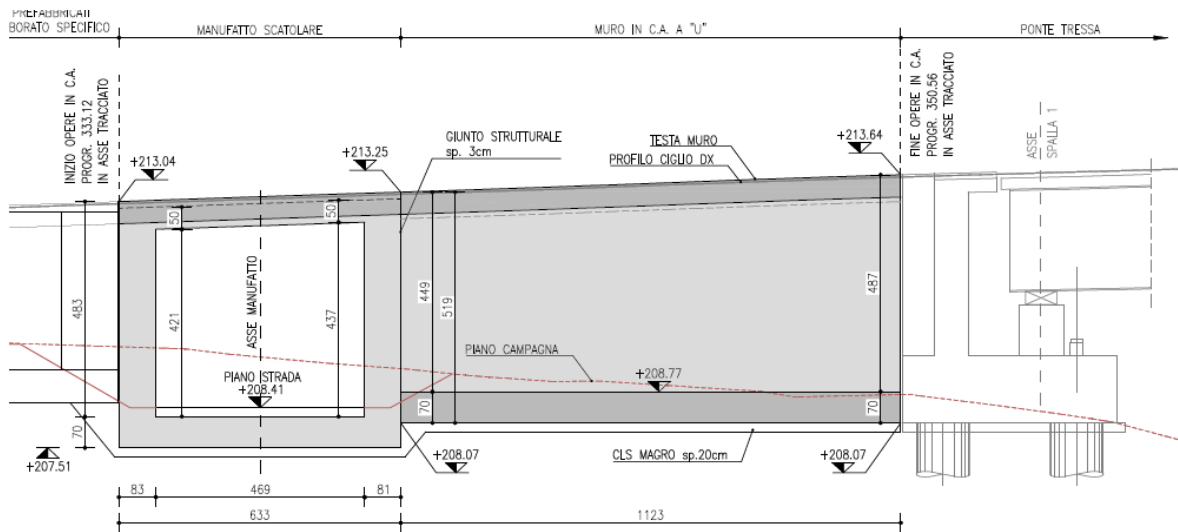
Scatolare e muro a U lato sud – carpenteria elevazioni
